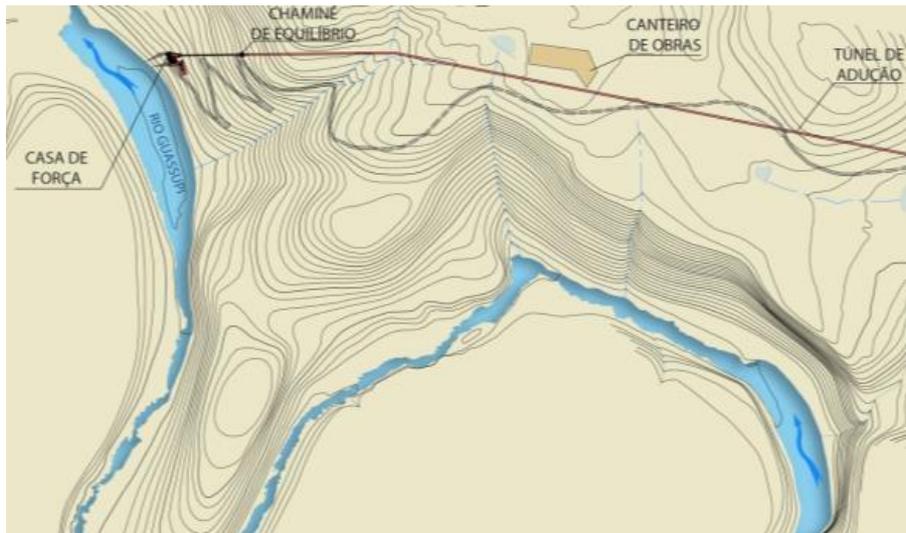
Detalhe da área da casa de força e canteiro de obras secundário da PCH Salto do Guassupi.
